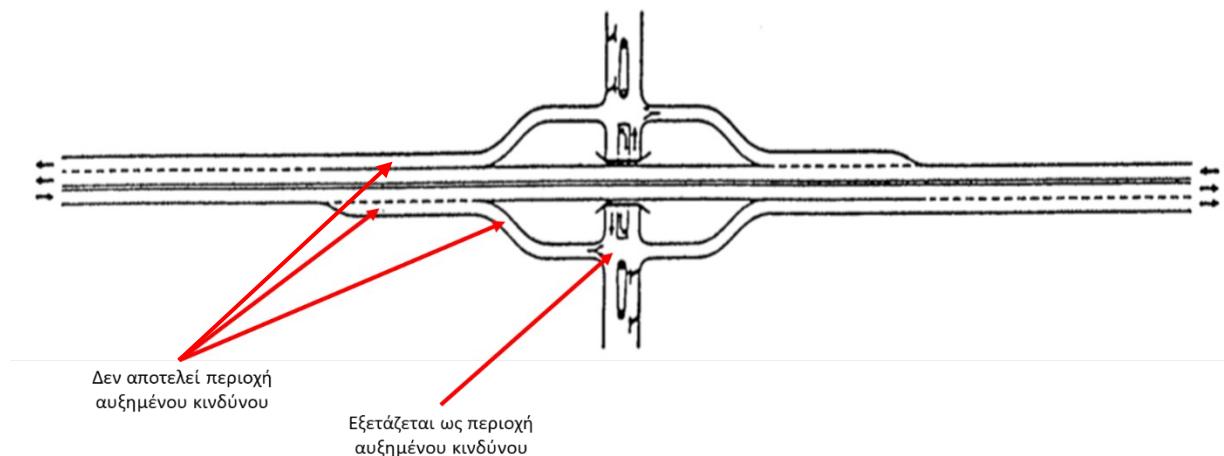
Route avec modification critique de la section transversale de la chaussée de type « $\beta 2+ 1$ » à un carrefour routier
